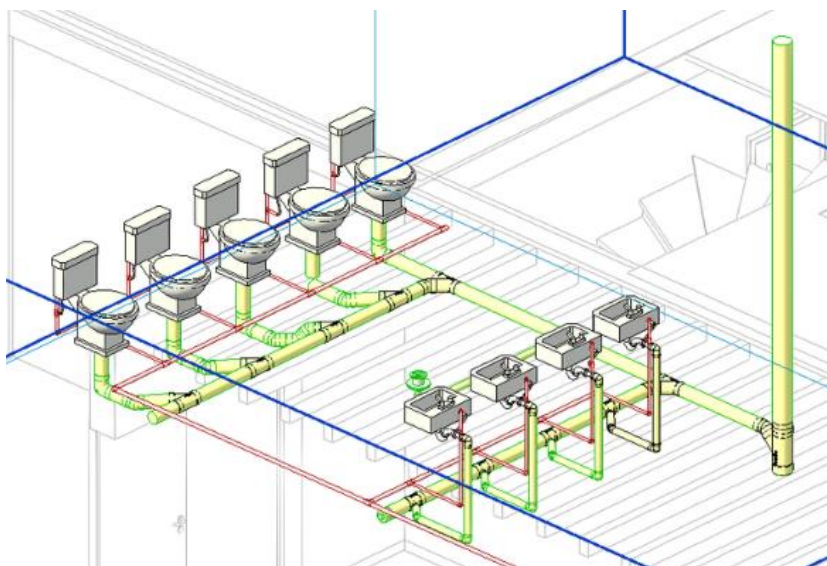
Modelado 3D arquitectónica. Elaboración propia.
